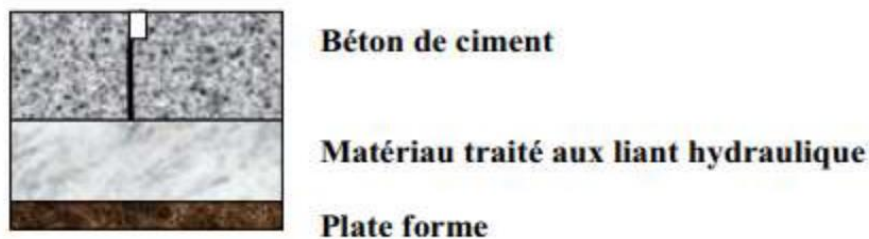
Dimensionnement d'une chaussée en béton de ciment (Meraga et Meghaouzel, 2020)
